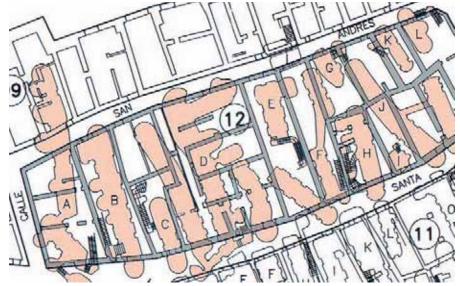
Detalle de una de las manzanas mostrando la densa disposición de las bodegas y su trazado bajo muros de carga, fachadas y calles.
